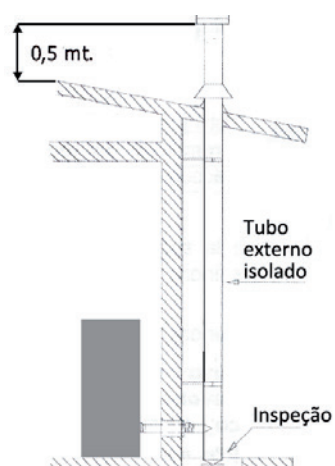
ligação a um tubo externo com tubo isolado ou parede dupla
